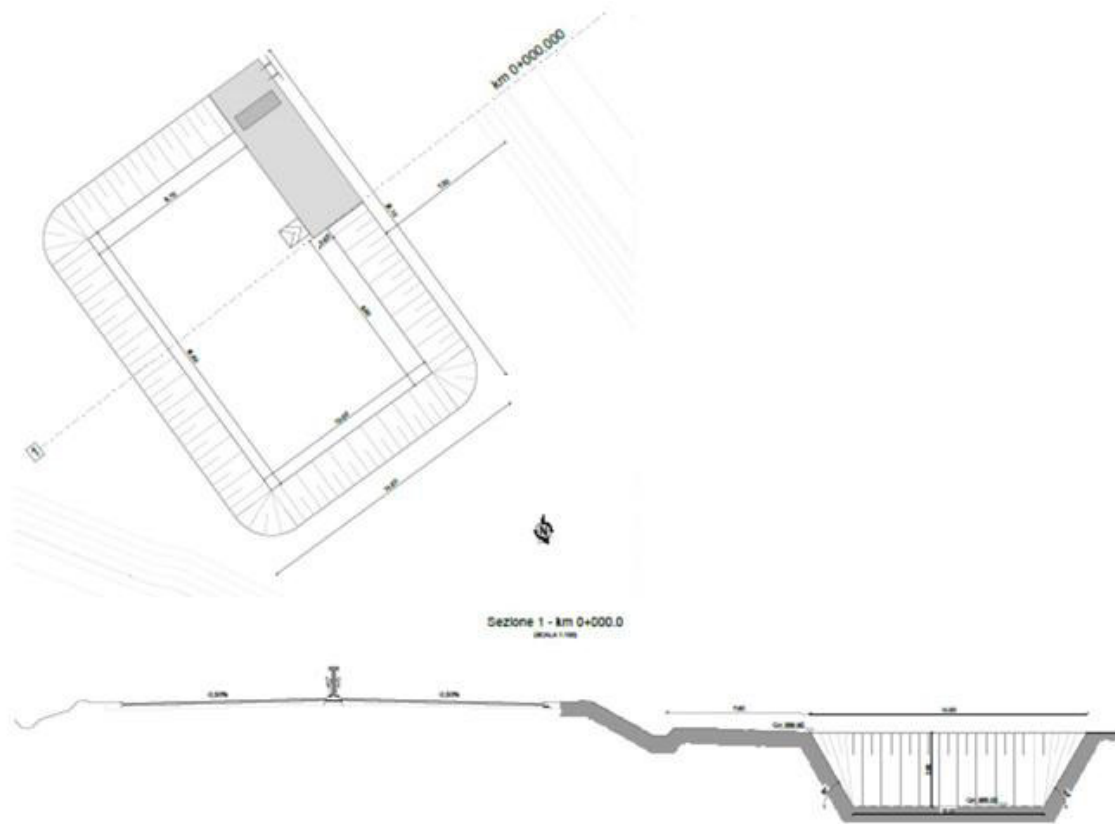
Vasca di 1° pioggia TA.1 e Vasca di Laminazione VP.1 - Stralcio planimetrico e Sezione
